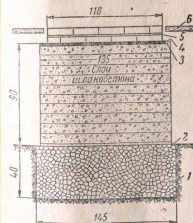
Фундамент сплошной шлакобетонный на песчаном грунте:
